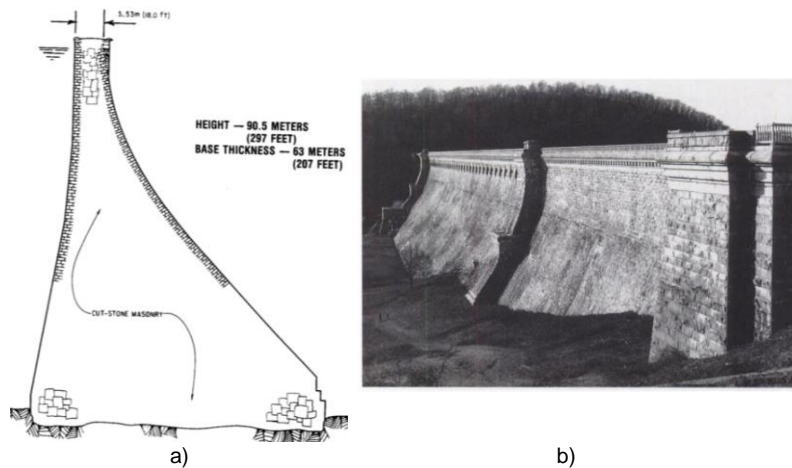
Barragem de New Croton: a) seção transversal (retirada de Jansen, 1983) e b) vista do paramento de jusante (retirada de Billington & Jackson, 2006).
